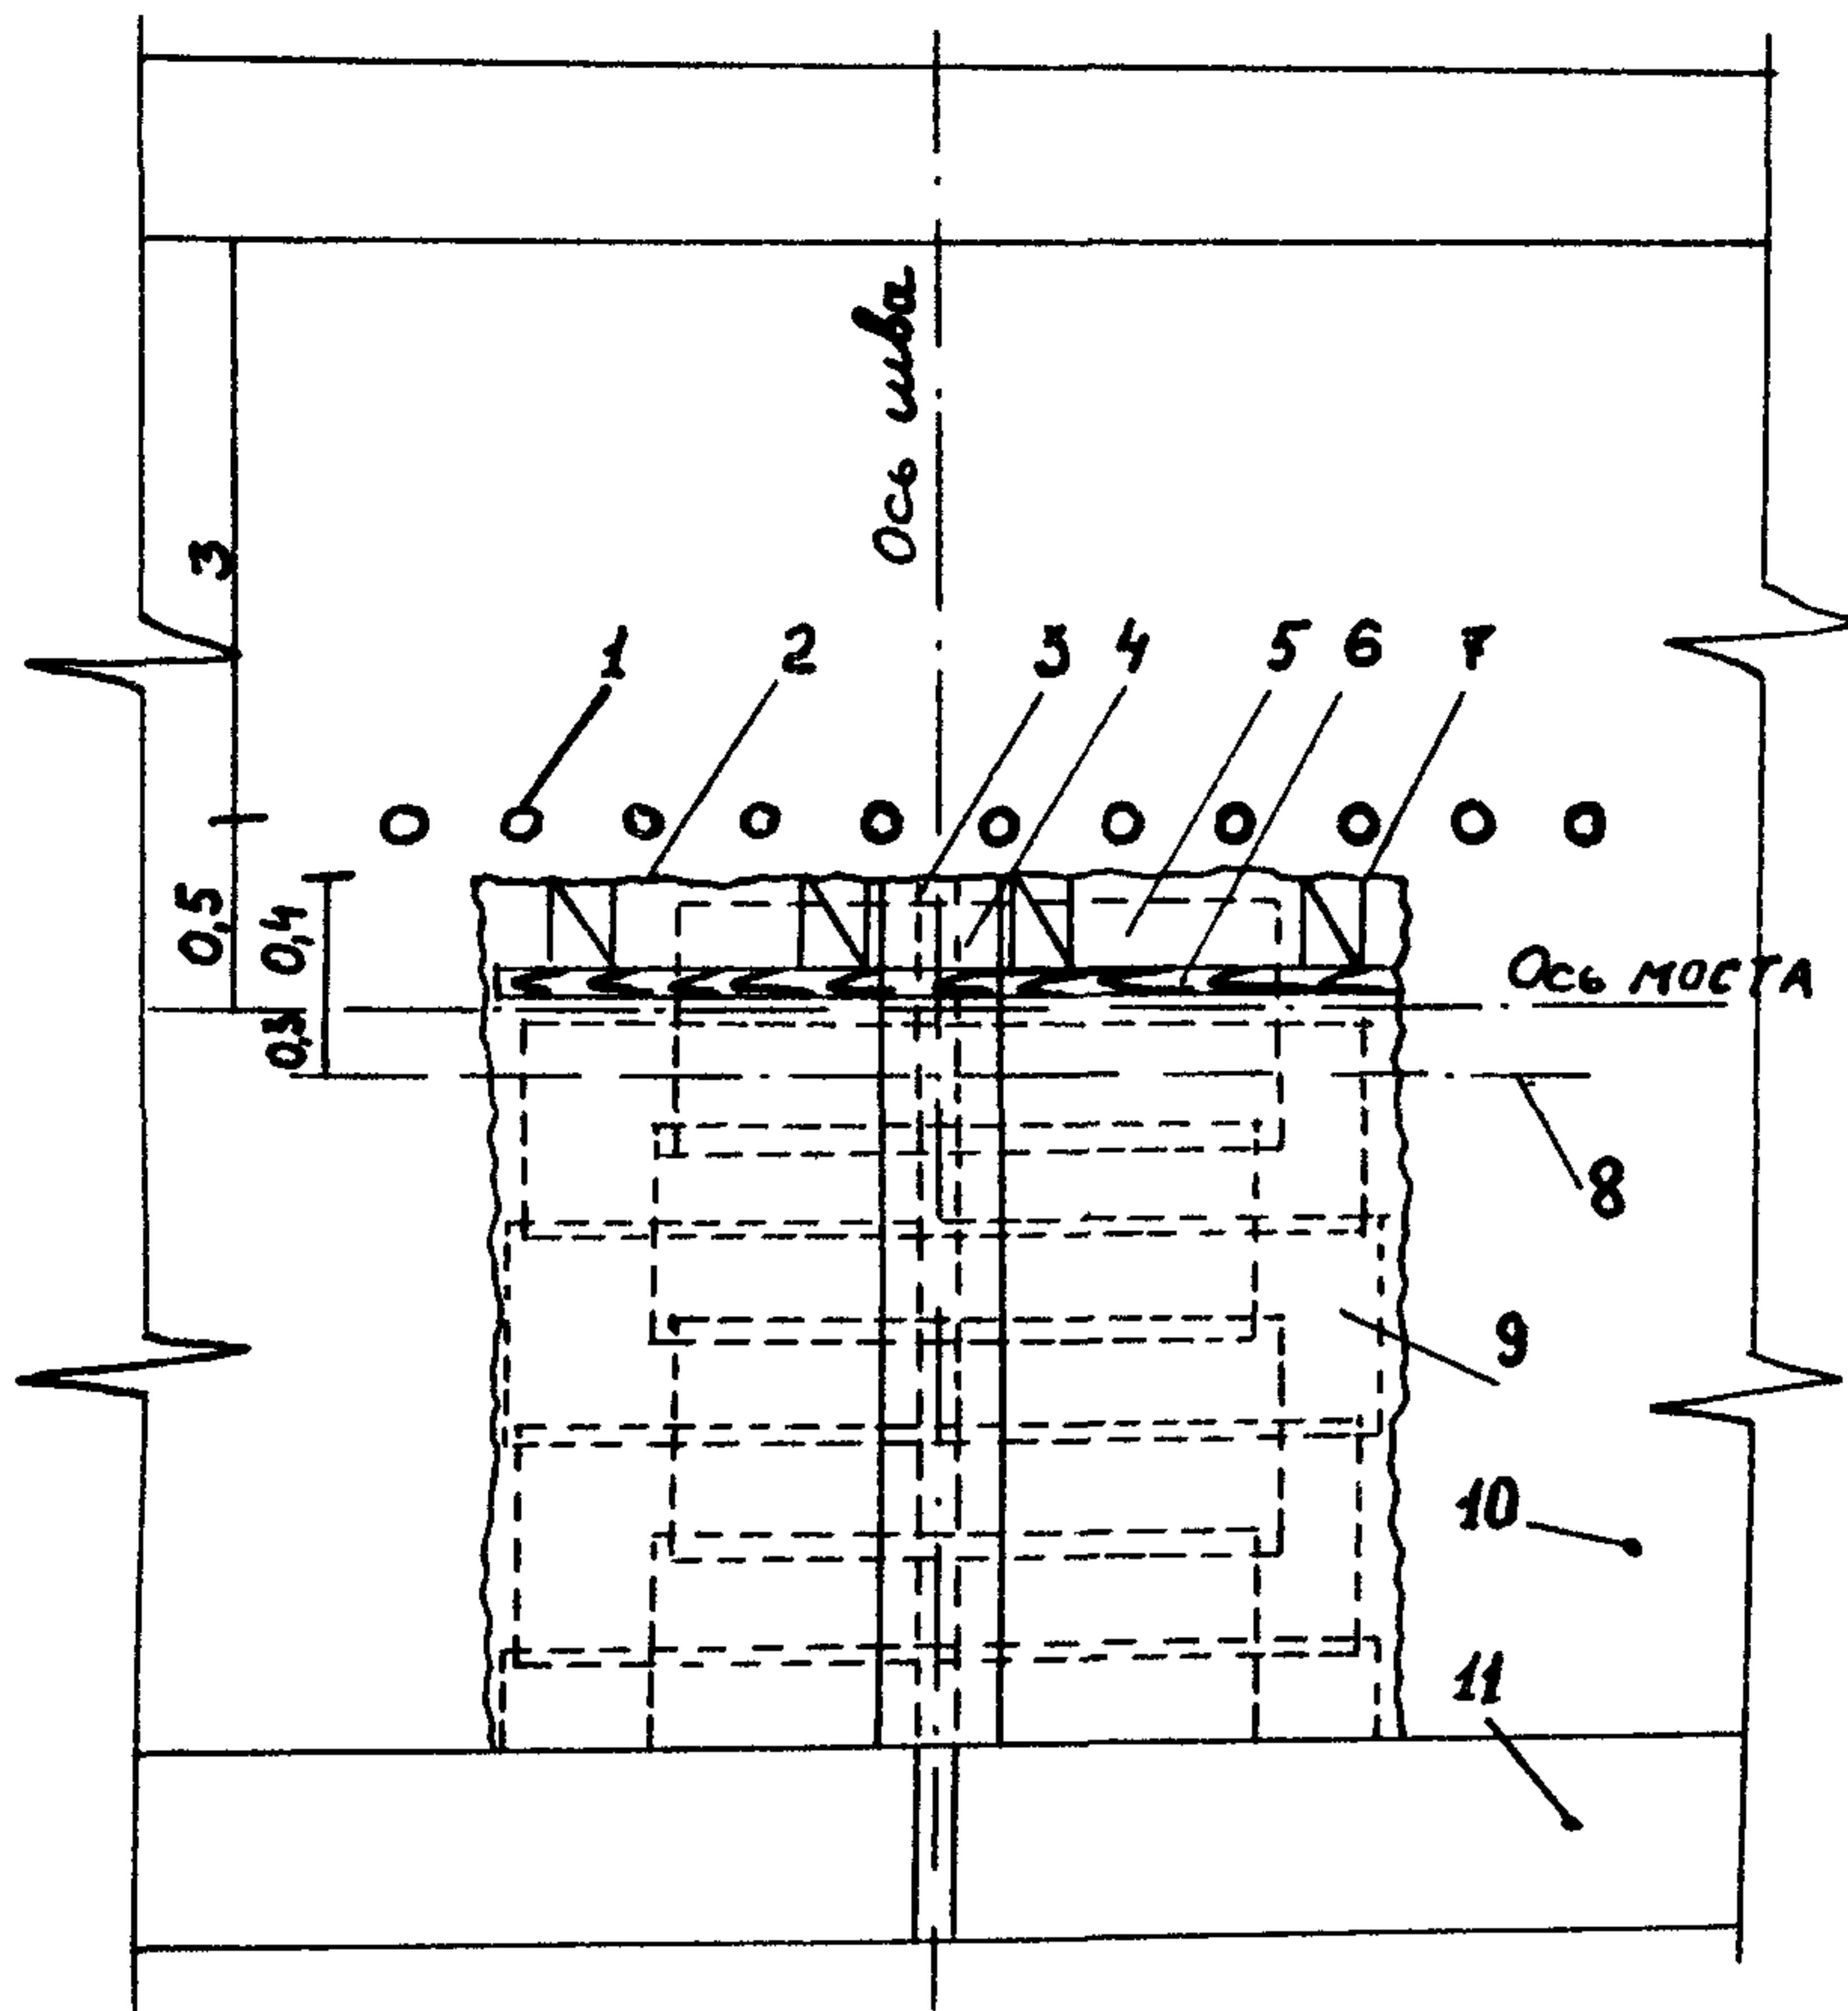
Схема укладки армирующей сетки при замене покрытия в швах закрытого типа с армированным асфальтобетоном:
